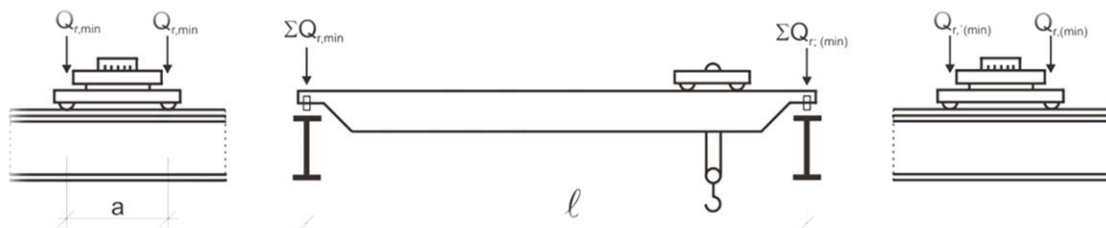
Disposition de charge de l'appareil de levage à vide pour obtenir un chargement minimal sur la poutre de roulement.
